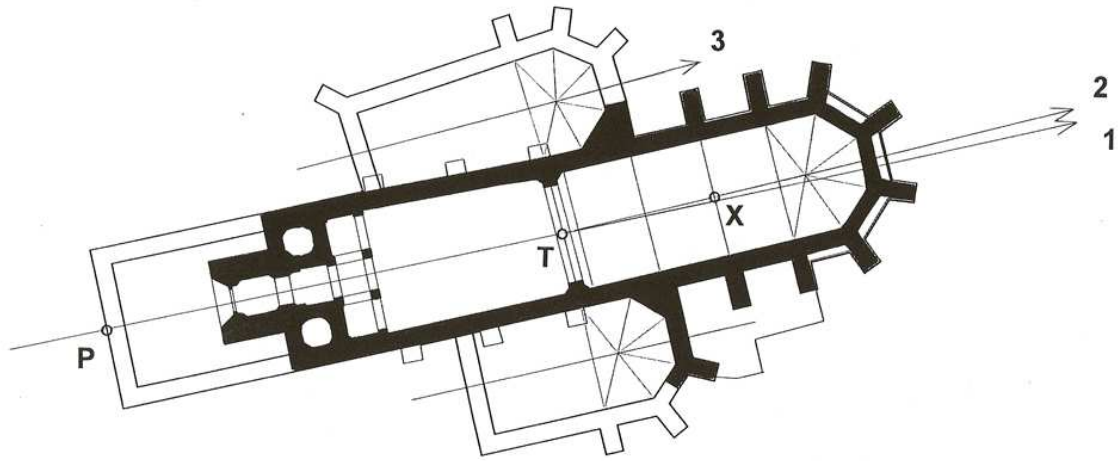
Grundriss der Pfarrkirche von Marchegg, mit Achsenknick, nach Erwin Reidinger 2010
